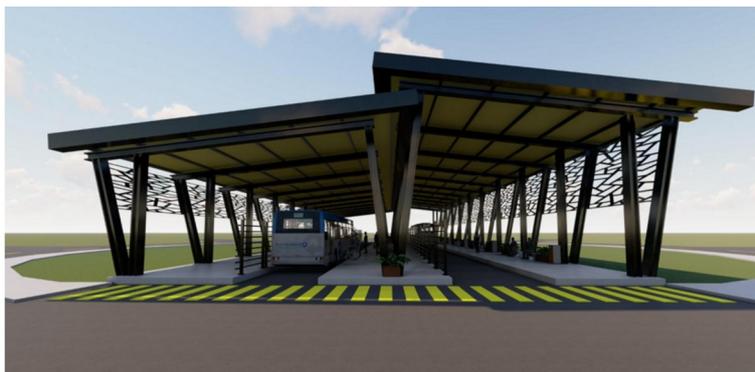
Croqui do projeto do Terminal “B” a ser implantado na Praça do Santuário.
